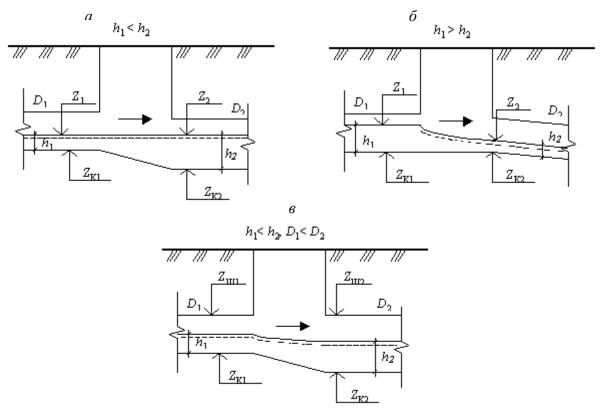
Сопряжение трубопроводов a – по уровню воды; δ – по дну; ϵ – по шелыгам
